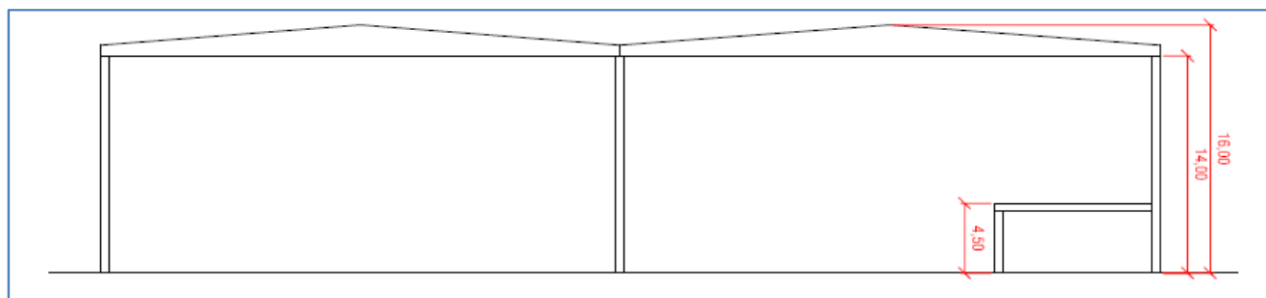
Plano sección escenario convencional Fuente Elaboración propia
